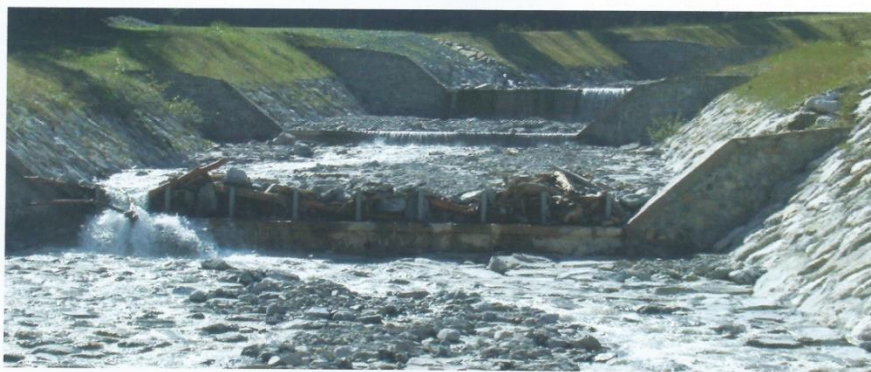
L'eliminazione dalle briglie dei materiali trasportati dalle piene ne consente la corretta funzionalità
